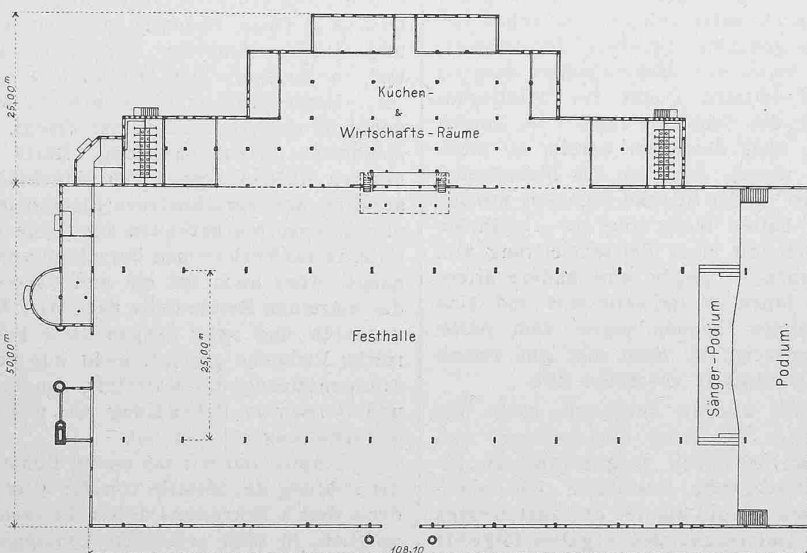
Grundriss. — Masstab 1 : 1000.
